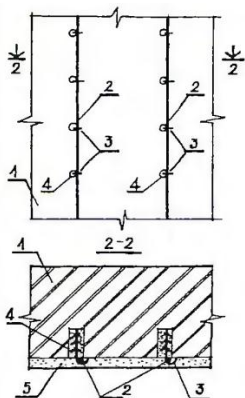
Усиление каменных конструкций односторонней железобетонной обоймой [7]: 1 – усиливаемая стена; 2 – продольная арматура; 3 – поперечные хомуты; 4 – отверстия для хомутов; 5 – штукатурка
